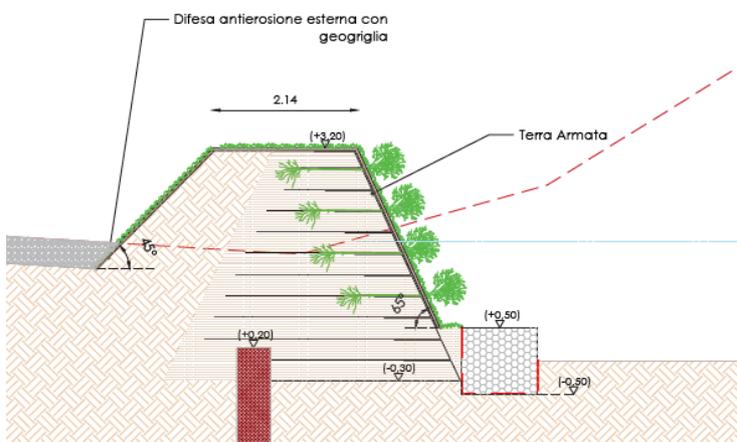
Sezione Bacino di Laminazione Particolare Terra Armata
